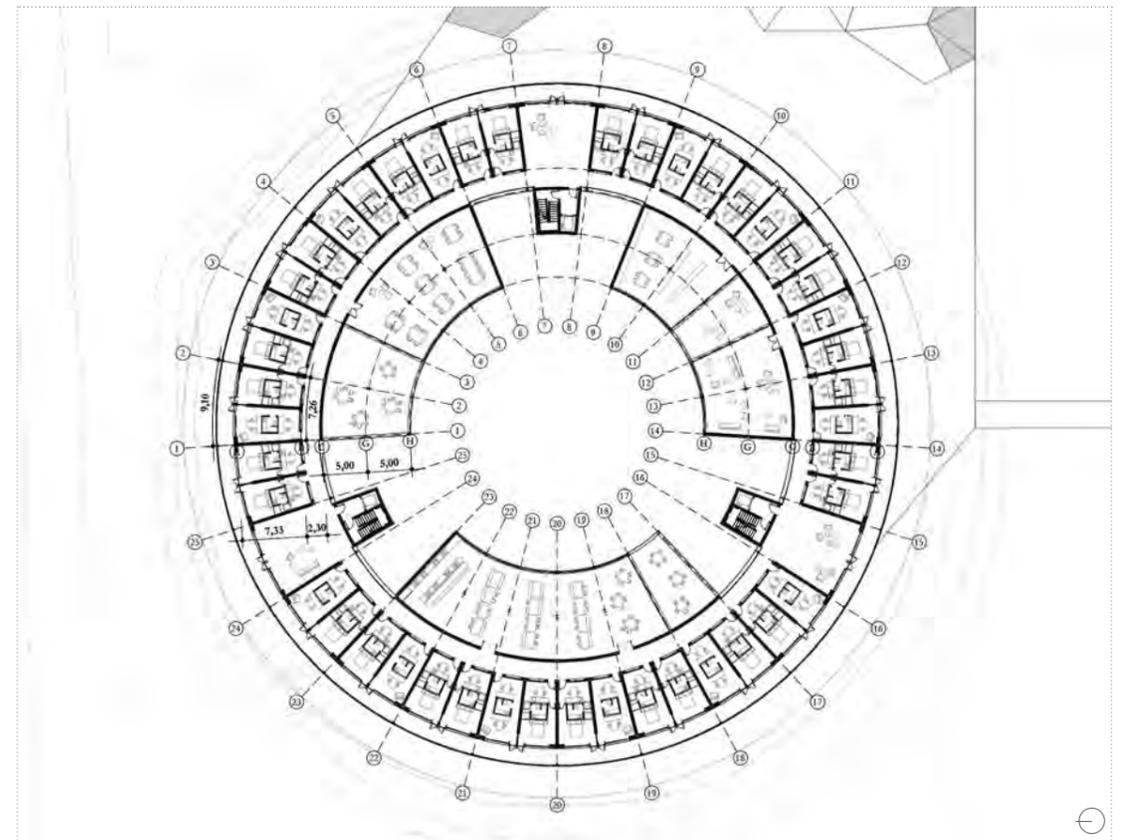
| Planta dos eixos estruturais (Silo B), Escala 1:800
